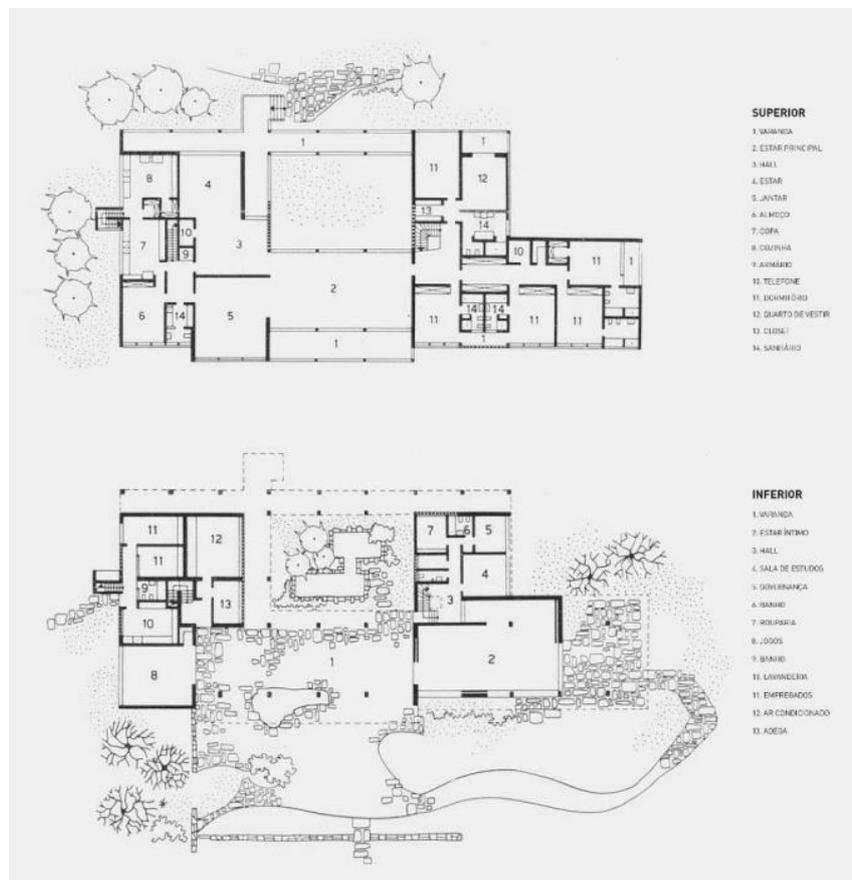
Residência Oscar Americano: planta baixa dos pavimentos superior (acima) e inferior (abaixo). Sem escala. Fonte: Acervo da biblioteca FAUUSP, coleção Oswaldo Bratke, código B737_728.3 O.
